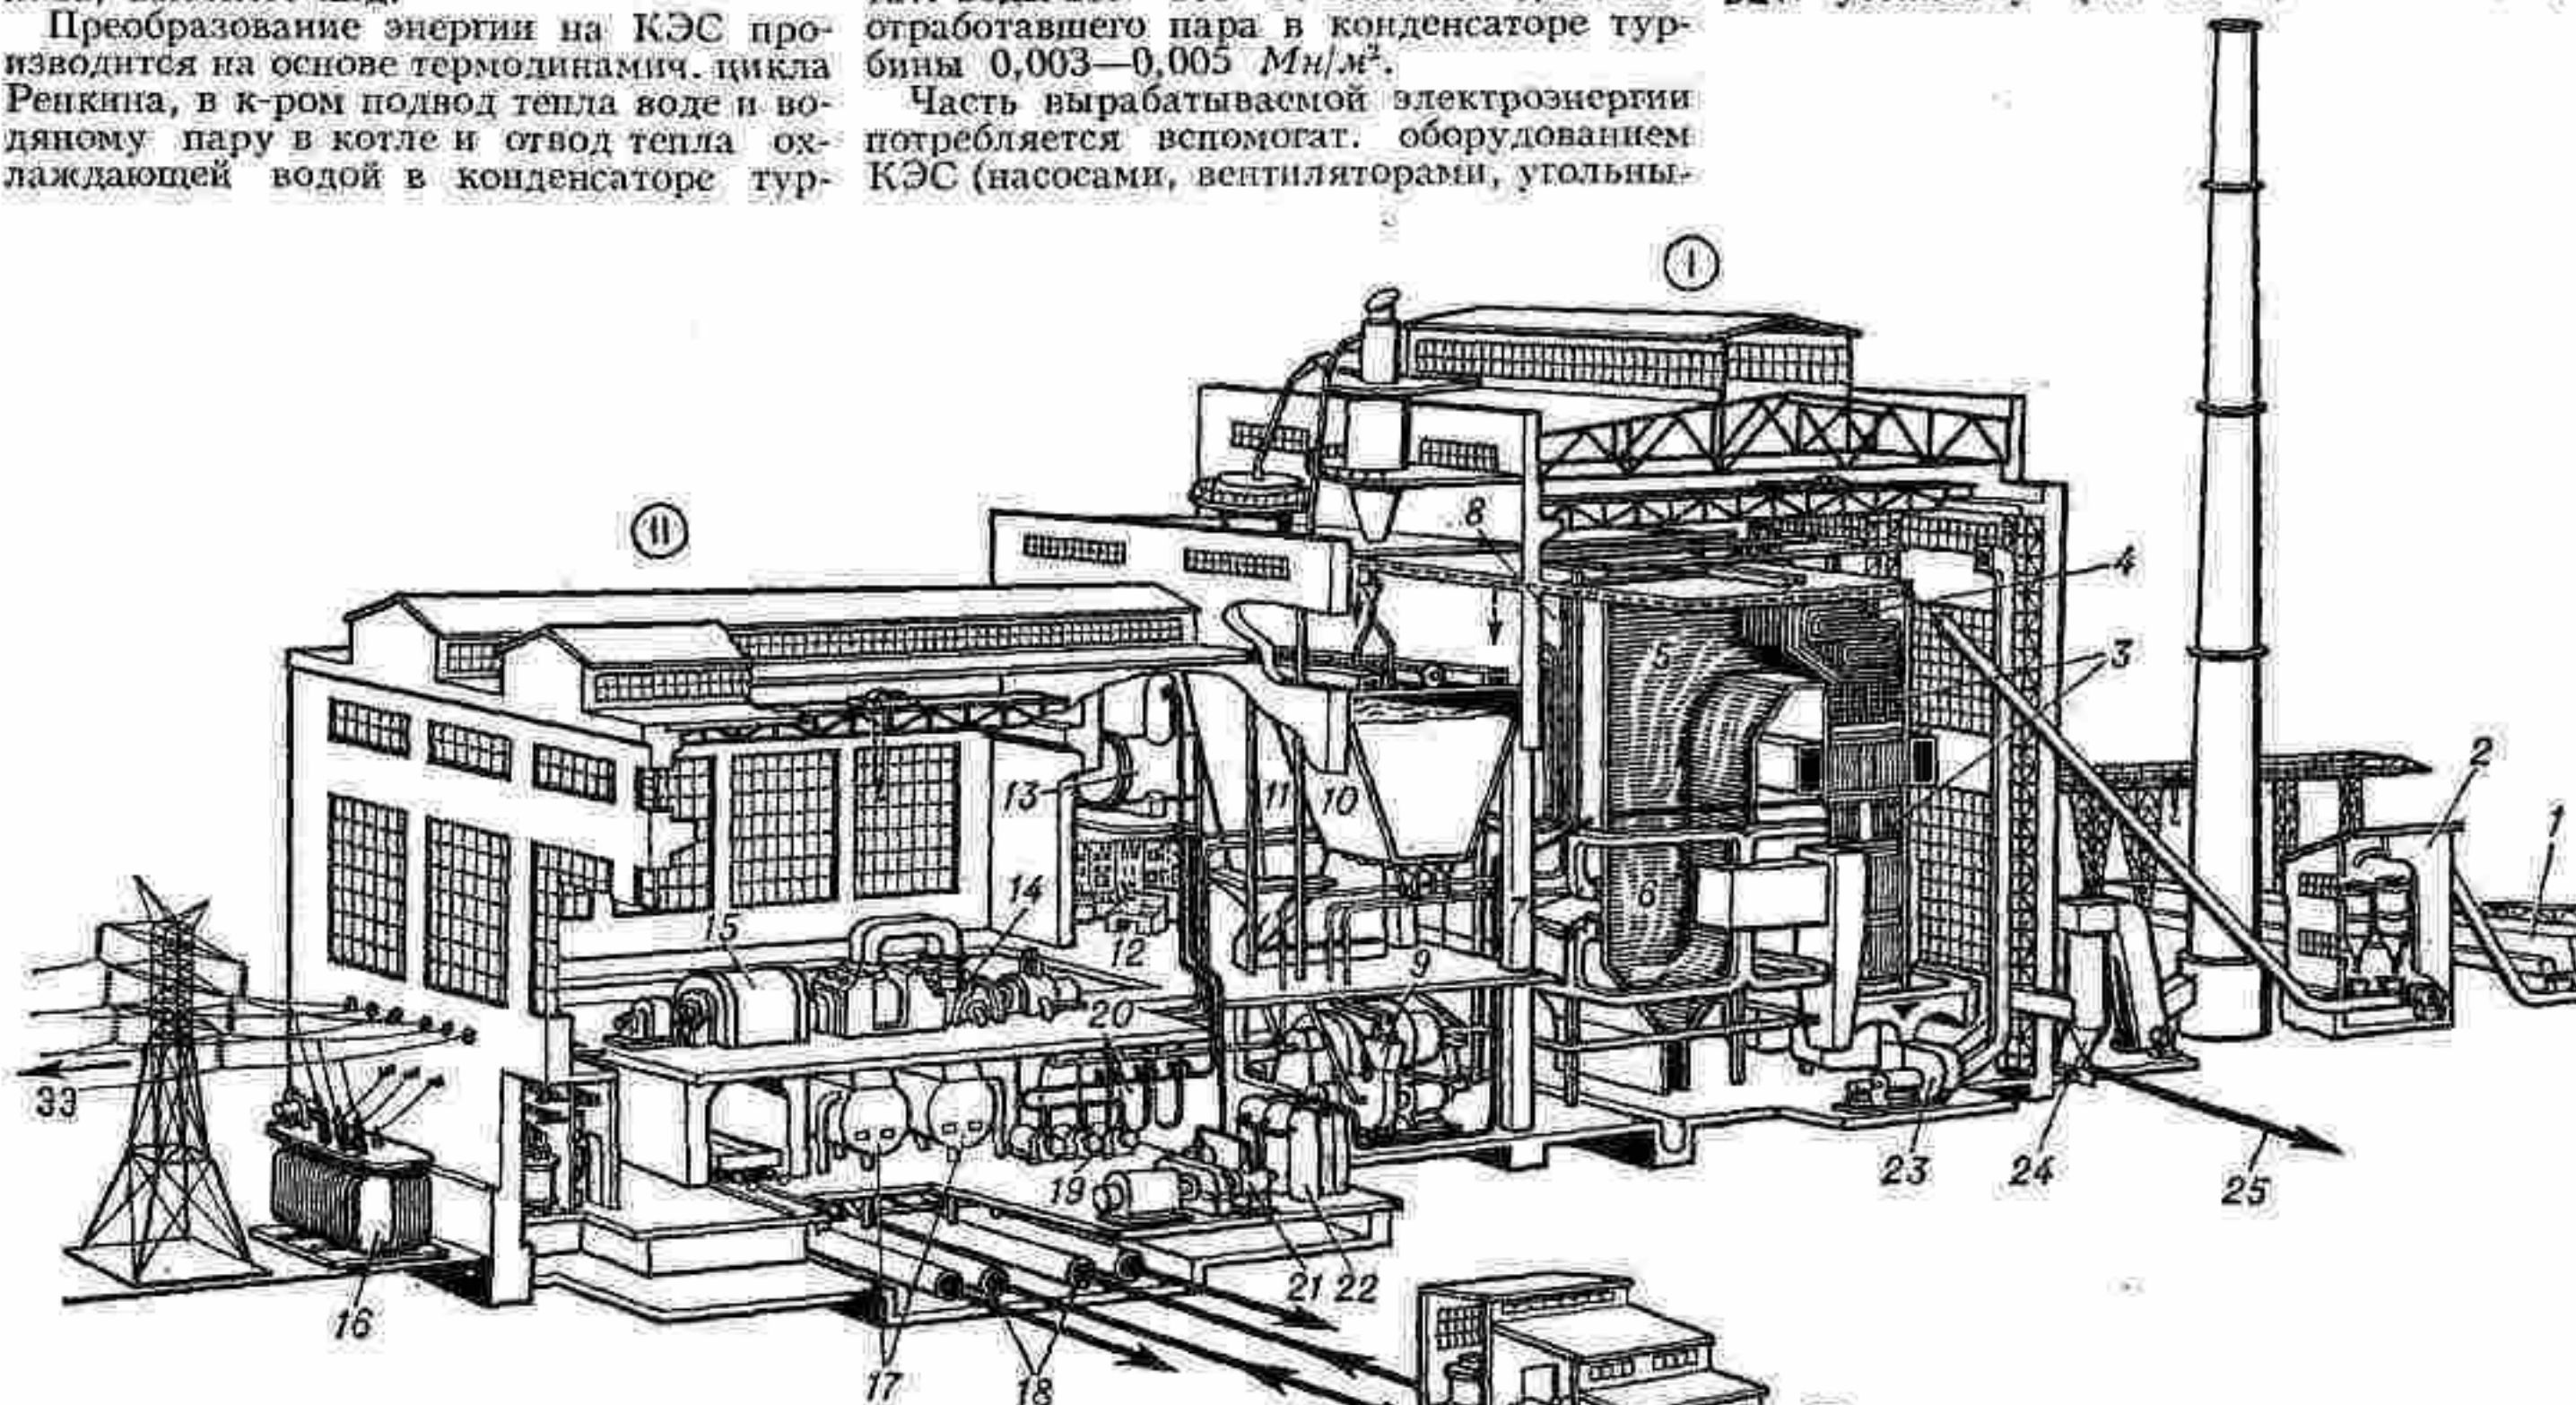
Пространственный вид (разрез) главного корпуса электростанции и связанных с ним устройств: 1 — котельное отделение; 2 — угольный склад; 3 — дробильная установка; 4 — береговая водонасосная установка; 5 — угольный экономайзер; 6 — пароперегреватель; 7 — паровой котёл; 8 — топочная камера; 9 — пылеугольные горелки; 10 — паропровод от котла к турбине; 11 — барабано-шаровая угольная мельница; 12 — бункер угольной пыли; 13 — бункер сырого угля; 14 — пульт управления блоком электростанции; 15 — деаэрактор; 16 — паровая турбина; 17 — электрический генератор; 18 — электрический повысительный трансформатор; 19 — паровые конденсаторы; 20 — трубопроводы охлаждающей воды; 21 — конденсатные насосы; 22 — регенеративные подогреватели низкого давления; 23 — регенеративные подогреватели высокого давления; 24 — дутьевой вентилятор; 25 — золоуловитель; 26 — шлак, зола; 27 — электрическая энергия.
